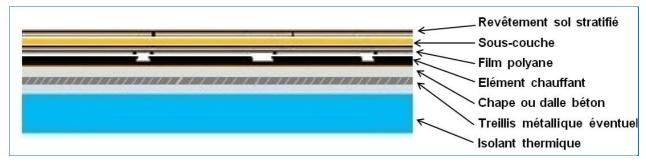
Mode de pose type 2 : Vue en coupe du plancher chauffant sous revêtement de sol stratifié
